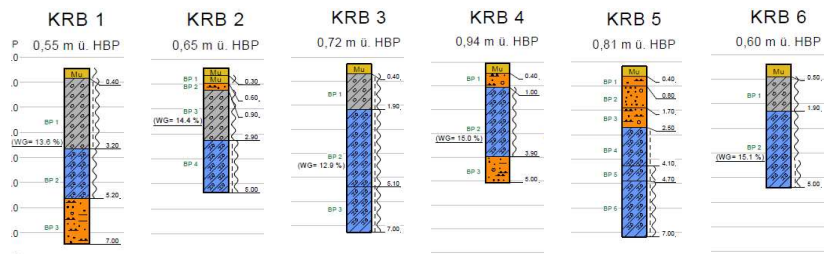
Lage der Bohrprofile, Baugrundlabor Lüneburg, 2025
